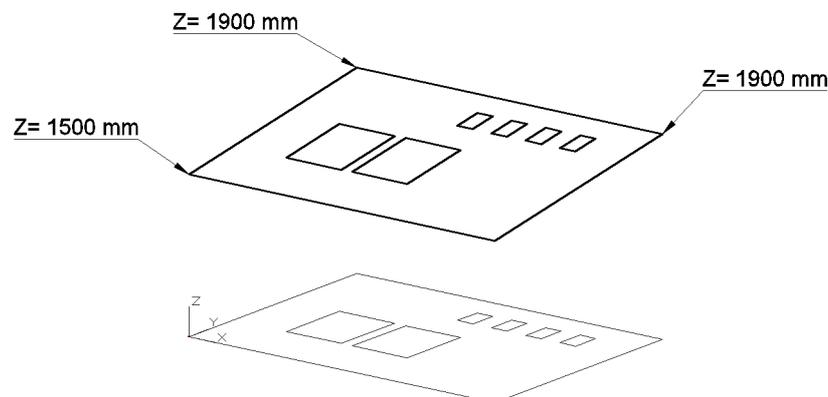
Grundrissfläche und projizierte Fläche im Raum
